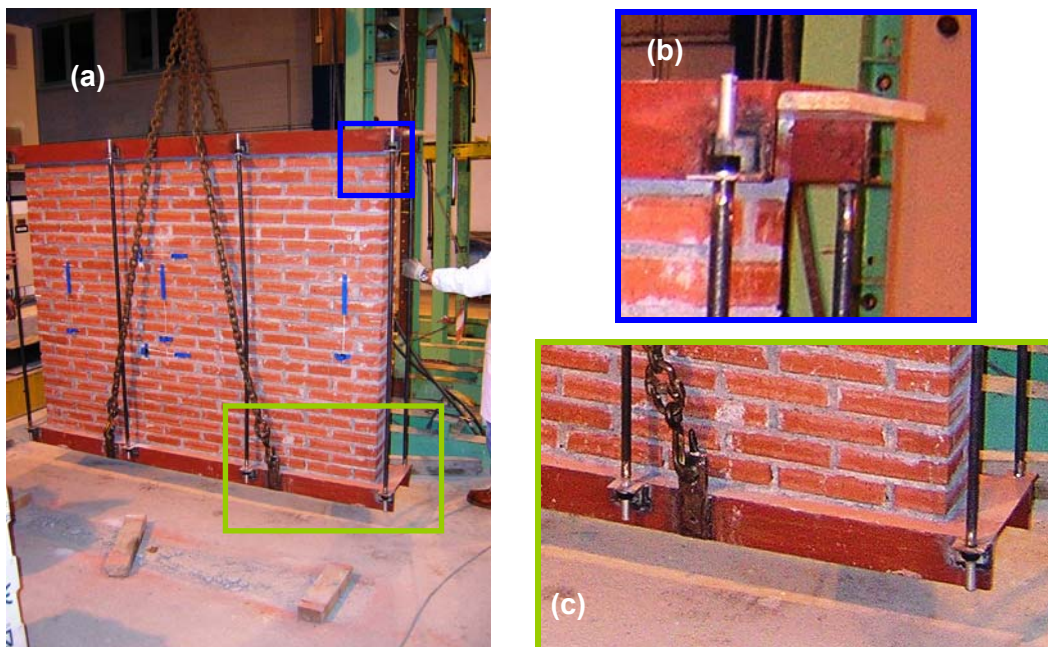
Detalles del sistema empleado para transportar el muro bajo el pórtico de carga.
